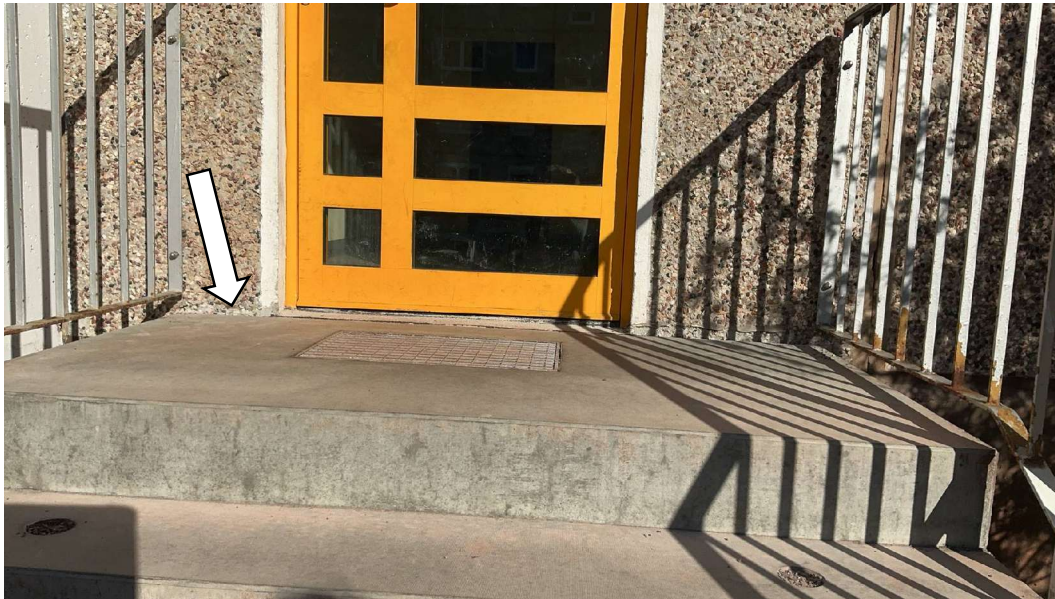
Ohne Befund: neue Treppe, Fassade, Nr. 31, EG
